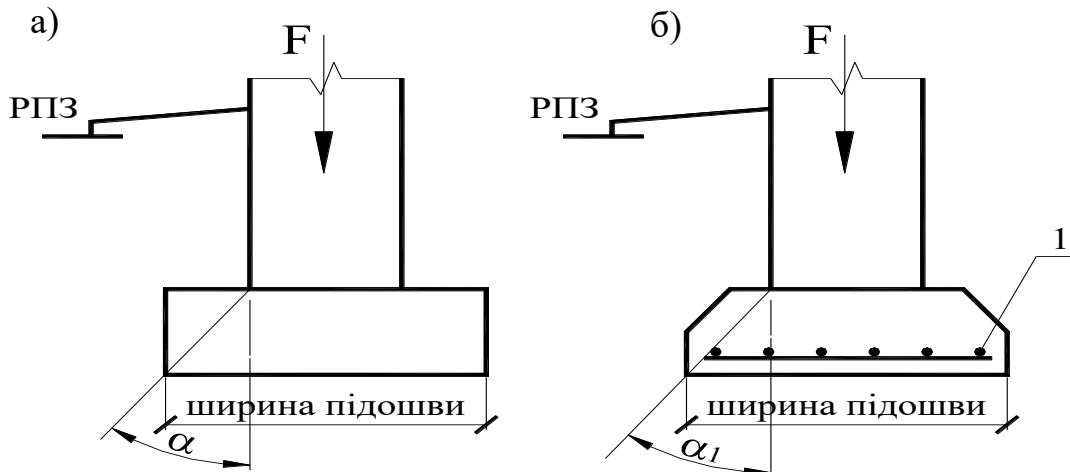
Типи фундаментів за умовами передачі навантаження основі:
